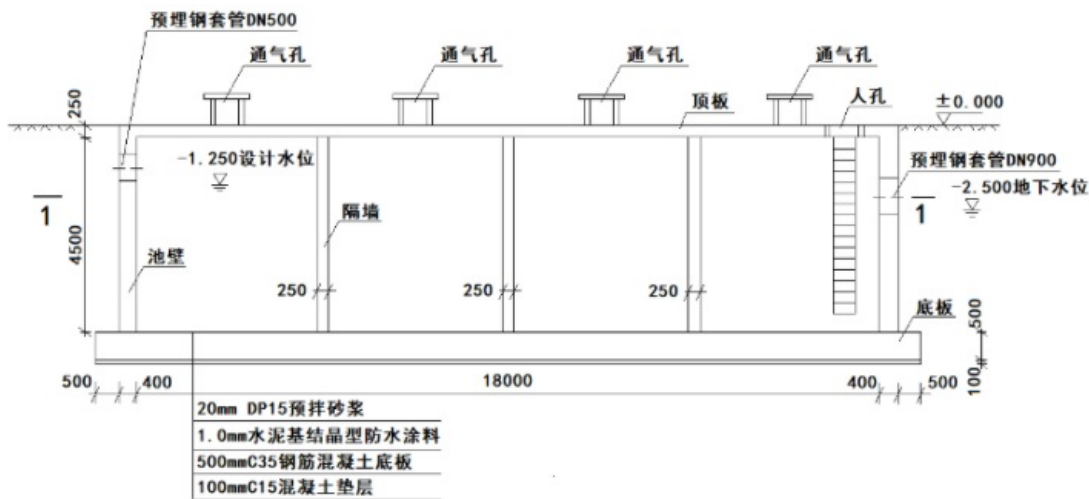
水池剖面图 (标高单位: m; 尺寸单位: mm)
